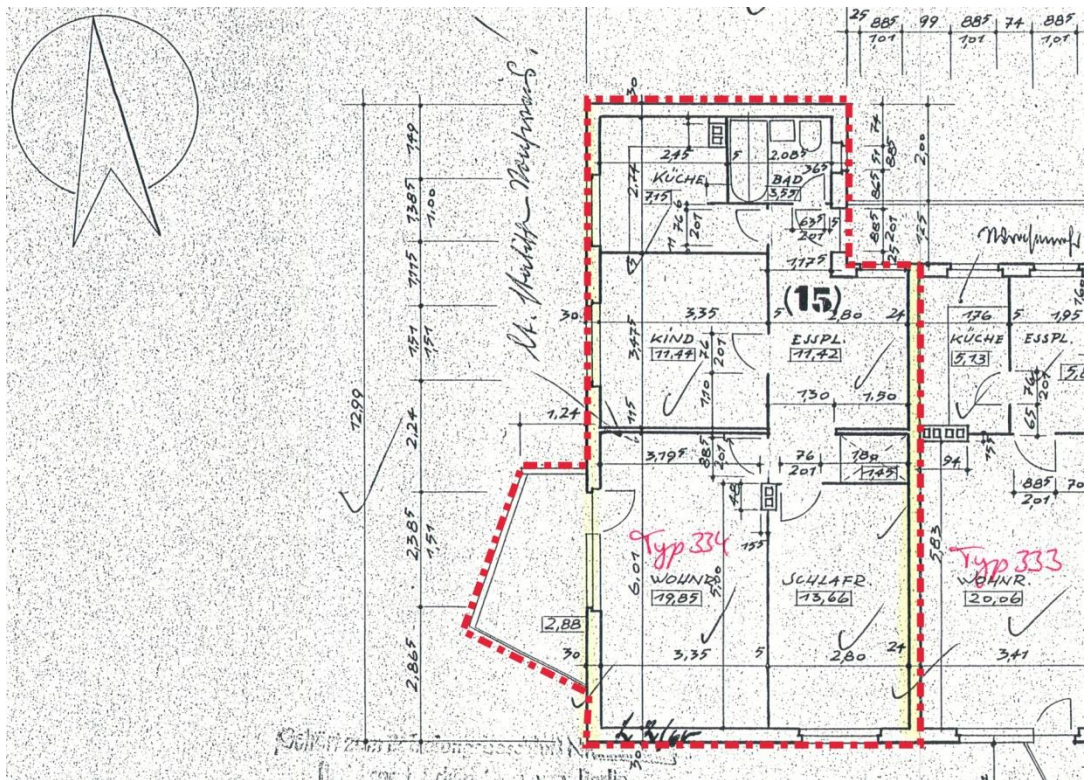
Grundriss Bestandsgebäude Am Mühlenberg 4
